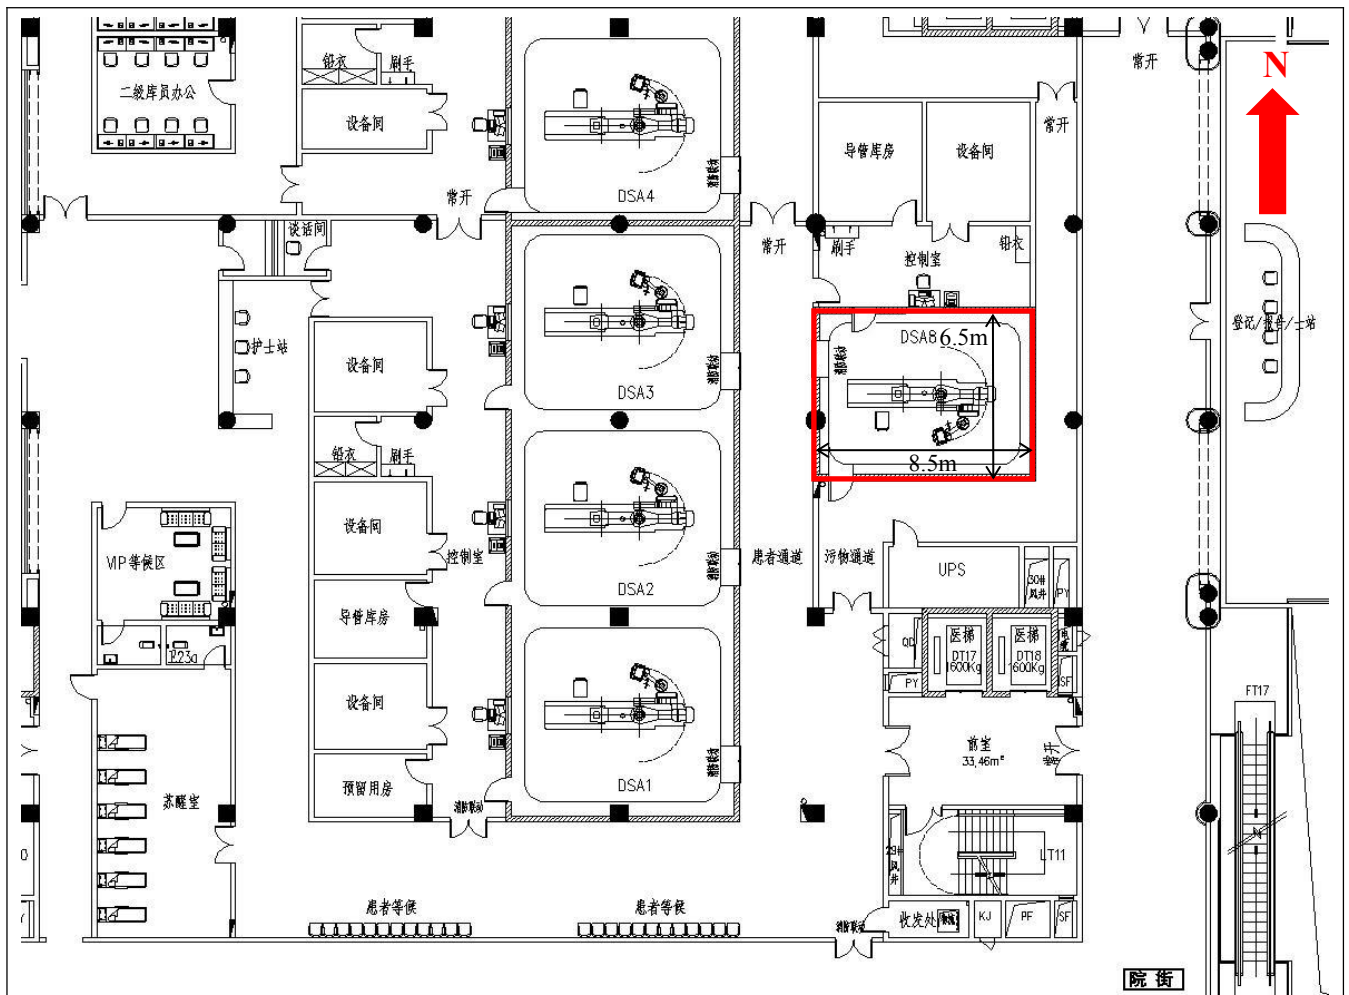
本项目验收 DSA 检查室 8 平面布置图 (局部)
